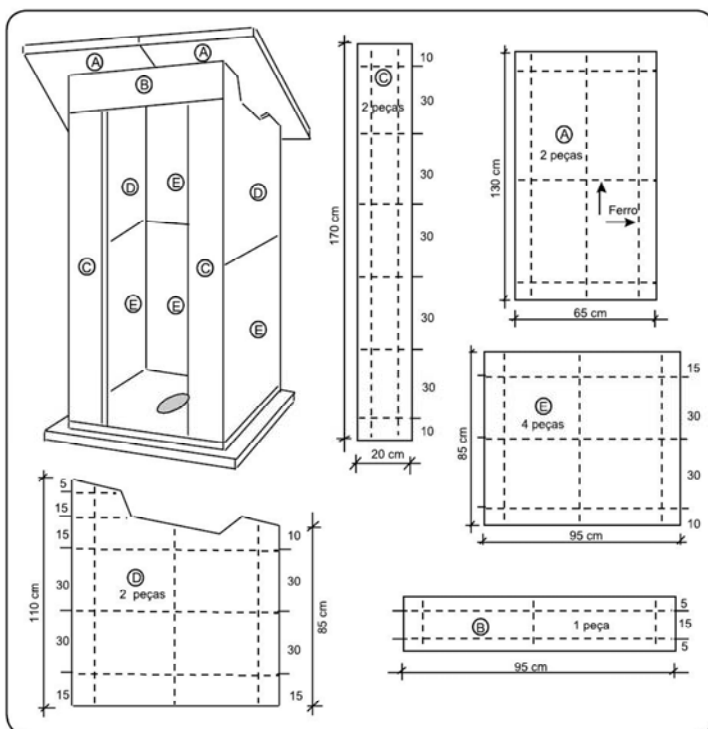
Casinha pré-fabricada em Placas de Cimento.
